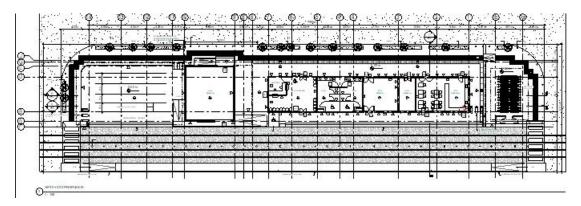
Planta arquitectónica propuesta (Municipalidad de Heredia, 2017)
